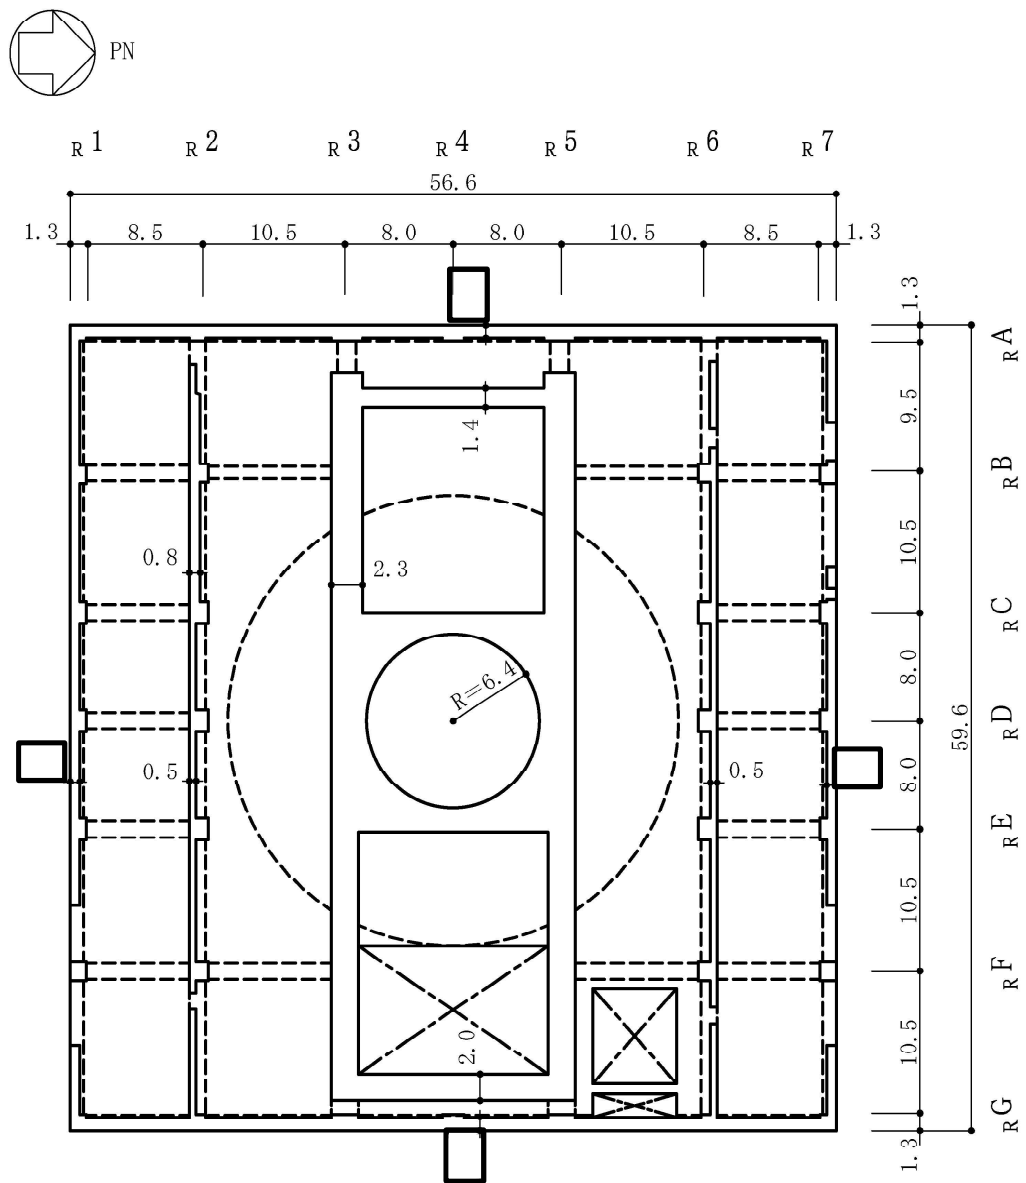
原子炉建屋の概略平面図 (3F, T.M.S.L. 23.5m) (6/9) (単位 : m)
